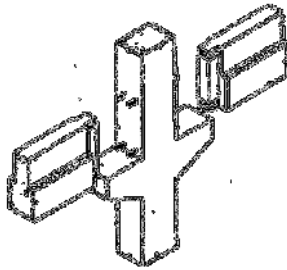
Sambungan Basah (*In-Situ Concrete Joint*)
